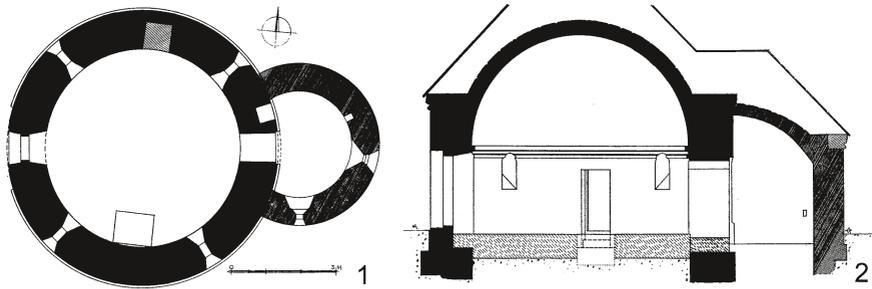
Altenfurt, Stadt Nürnberg. 1 Grundriss (nach Gebeßler 1961, 23); 2 Aufriss (nach Gebeßler 1961, 24).
